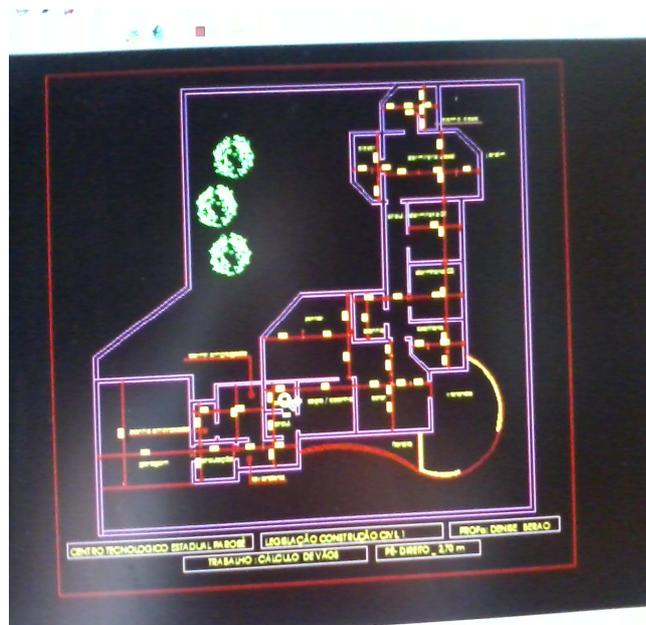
Planta Baixa Para Exercício 1 no autocad
